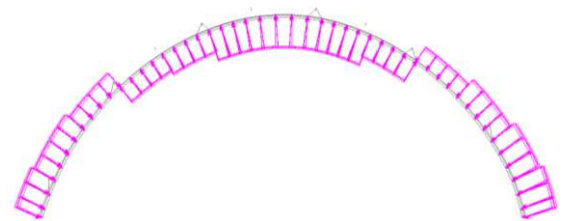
Загружение в ПК SCAD на фрагмент покрытия от ветровой нагрузки (X-)
